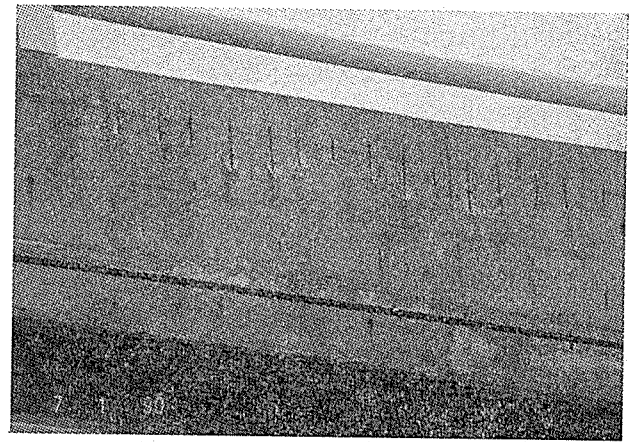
壁高欄、かぶり不足鉄筋の発錆およびかぶり部コンクリートのはく離
